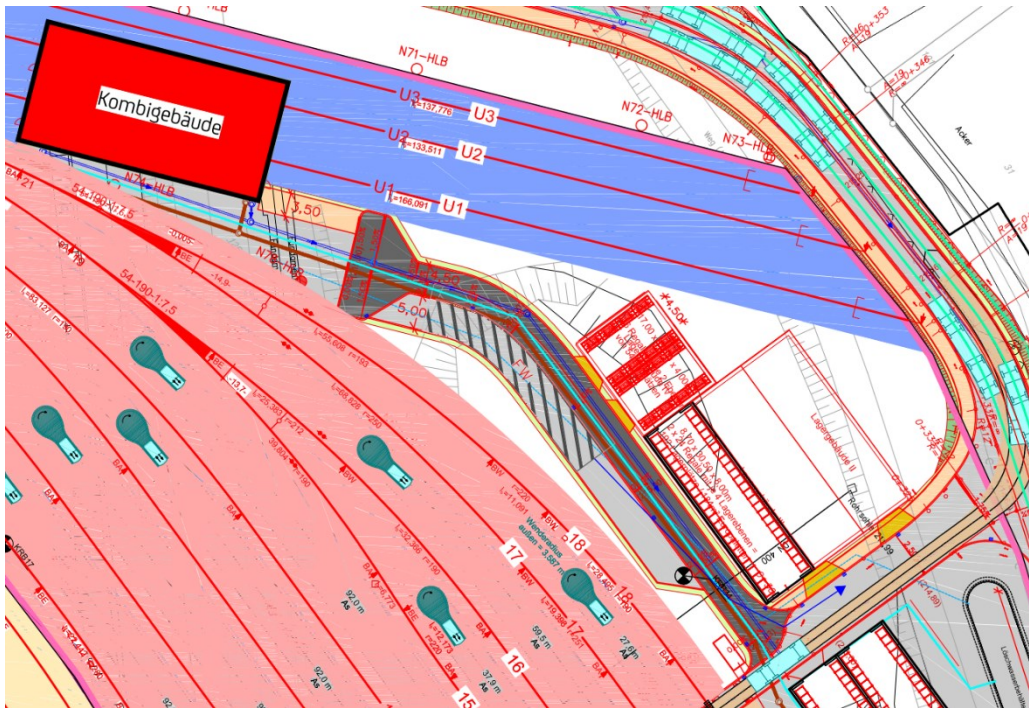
Ausschnitt aus /Lageplan/ mit Bewegungsfläche (FW)
